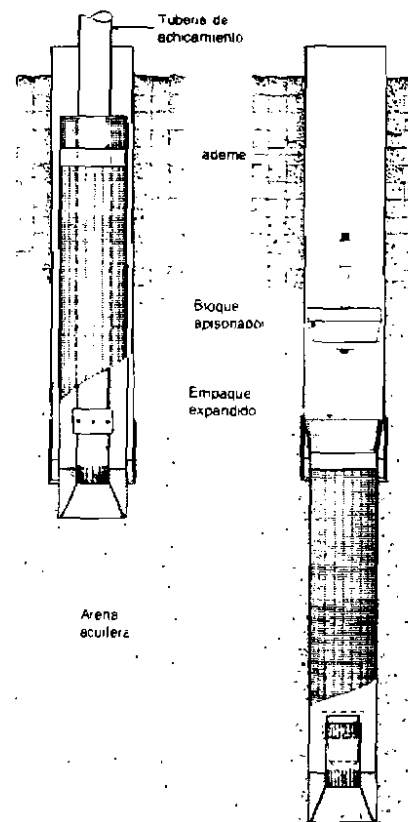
(Izquierda) Disposición de rejilla y accesorios de achicamiento, para dar comienzo a la operación, y (derecha), etapa final de la instalación de la rejilla por el método de achicamiento.
